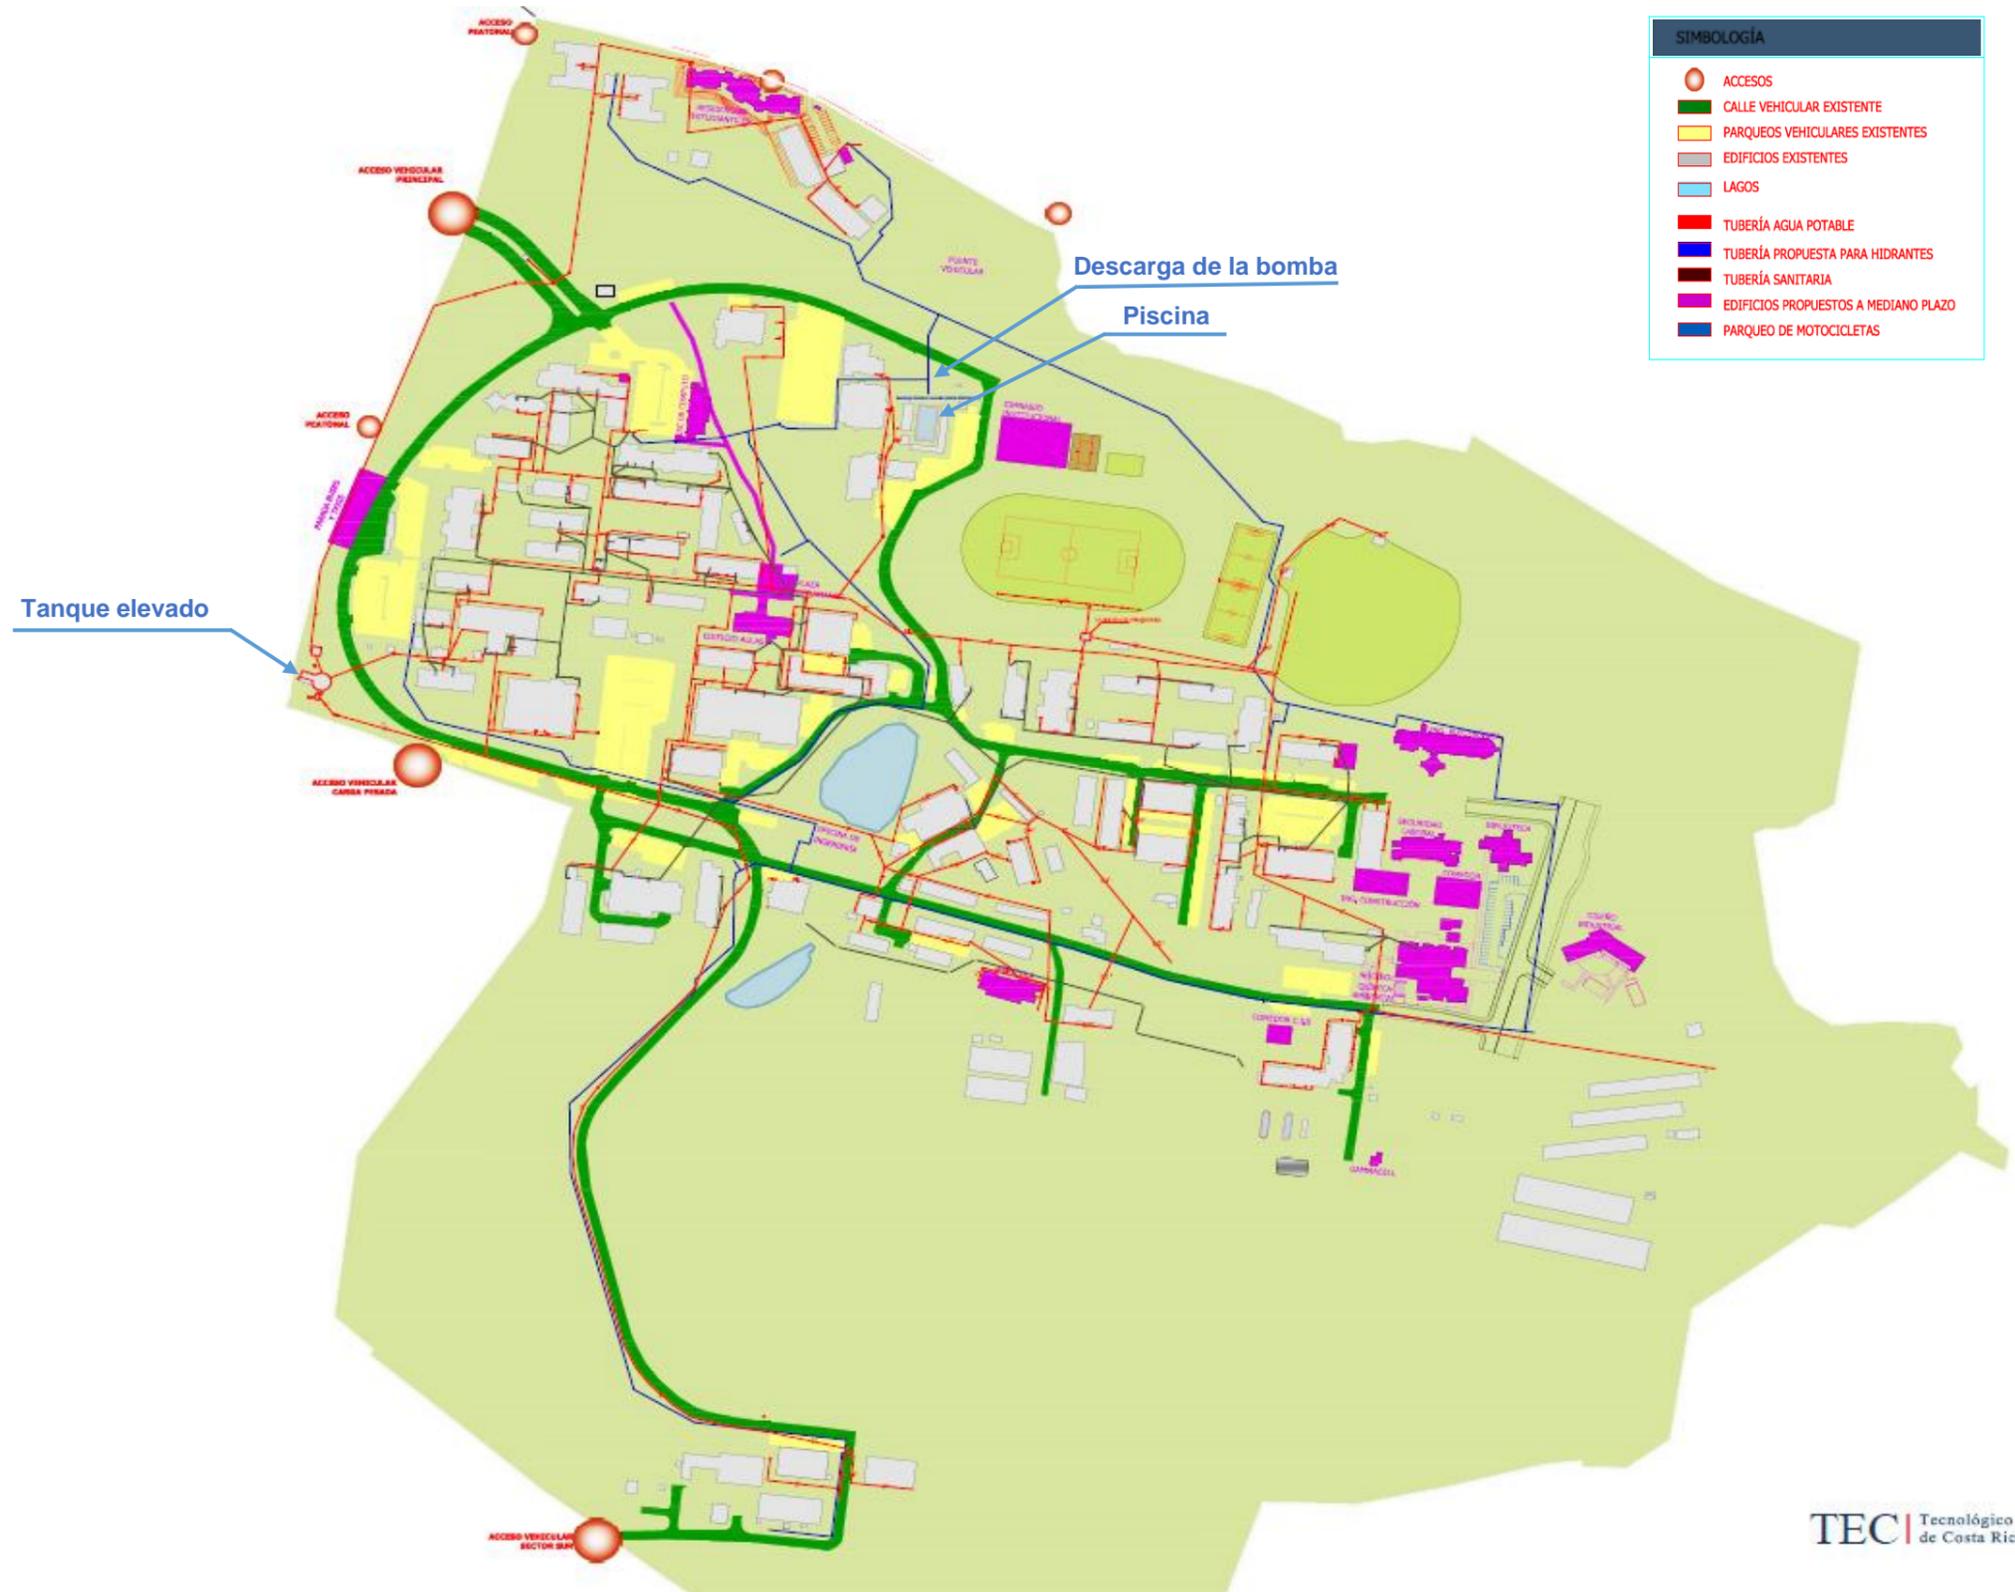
Distribución de tuberías propuesta para el sistema contra incendio (Fuente: Elaboración propia en AutoCAD 2014)
